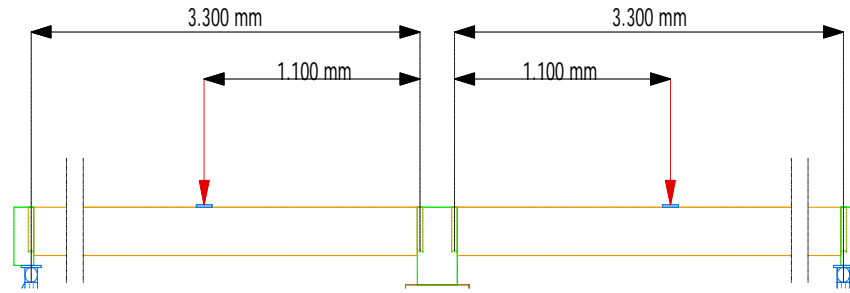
Distancia entre ejes de los apoyos y distancia de punto de aplicación de la carga al eje de la espiga del apoyo sobre la viga central
